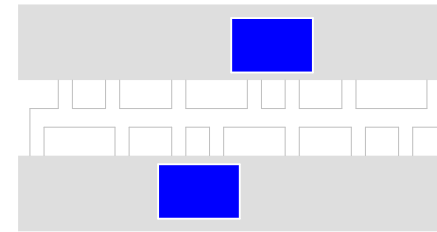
Verortung Gemeinschaftsräume Dachgeschoss | M 1.1500
